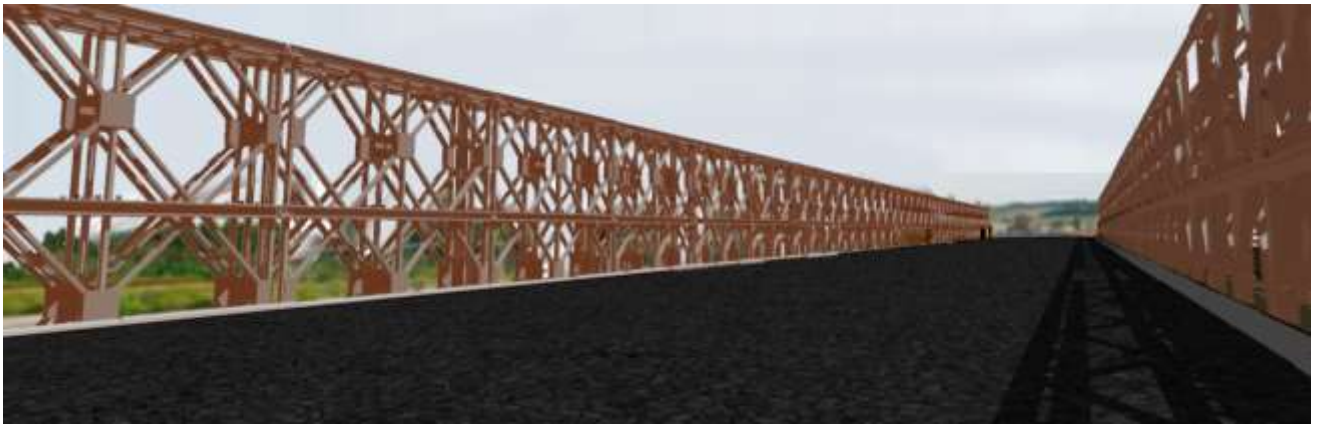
Vista 3D del nuovo ponte da Progetto Esecutivo.
